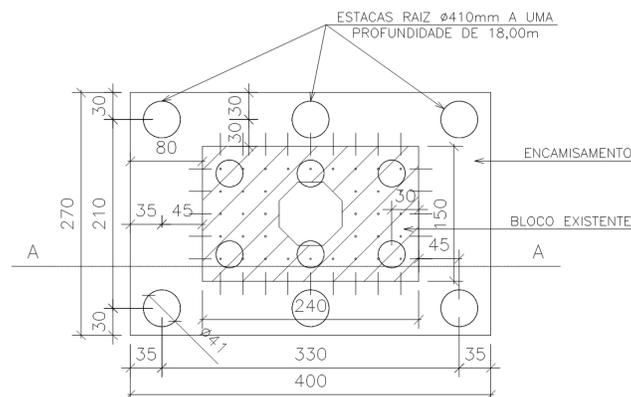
Detalhe da ligação entre bloco novo e bloco existente (VITÓRIO. (2014)).
